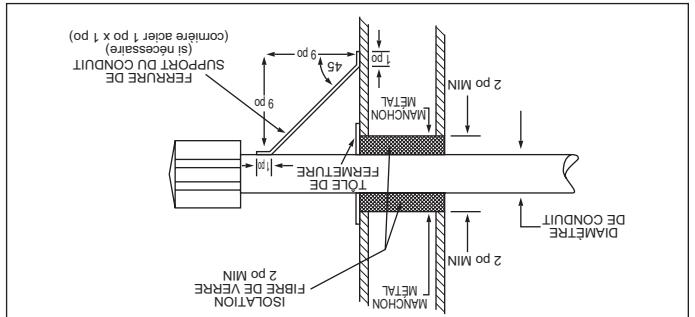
Construction d'une traverse à travers une paroi combustible et support de cheminée
